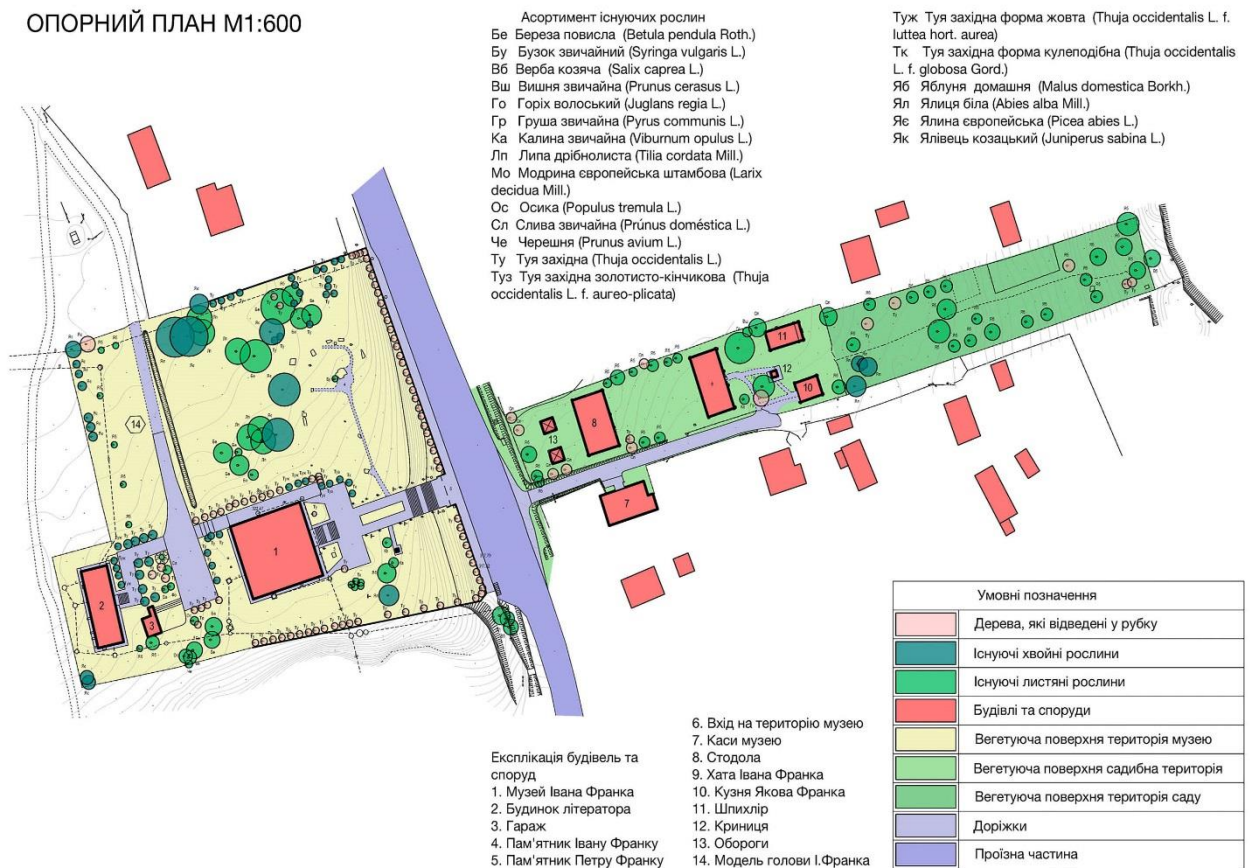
Опорний план насаджень на музеї-садибі І.Франка у Нагуєвичях.
